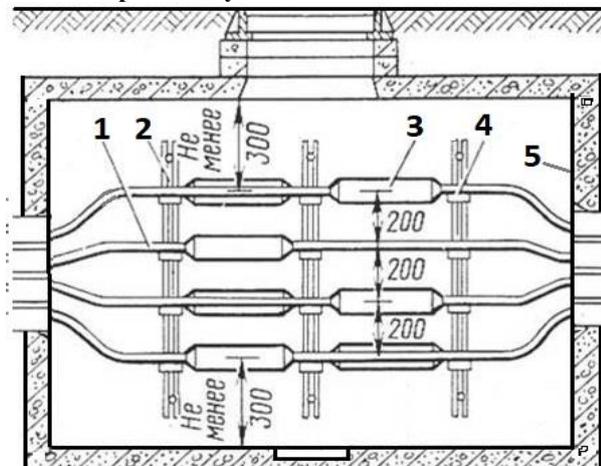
Установка консолей для кабелей с медными жилами в проходном колодце:
